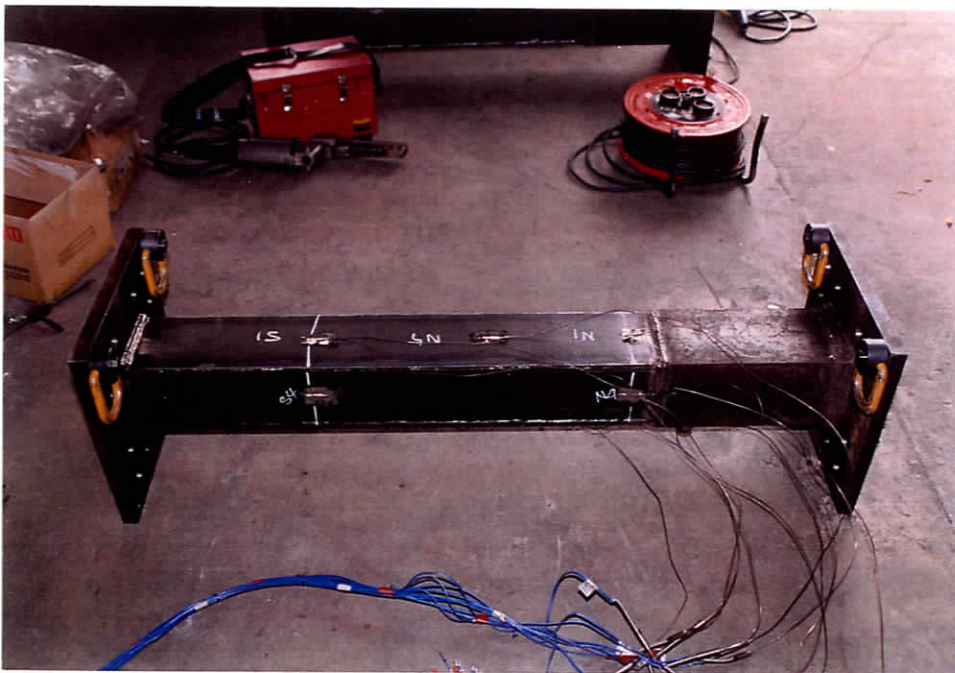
熱電対取り付け状況 (箱形断面部材)
